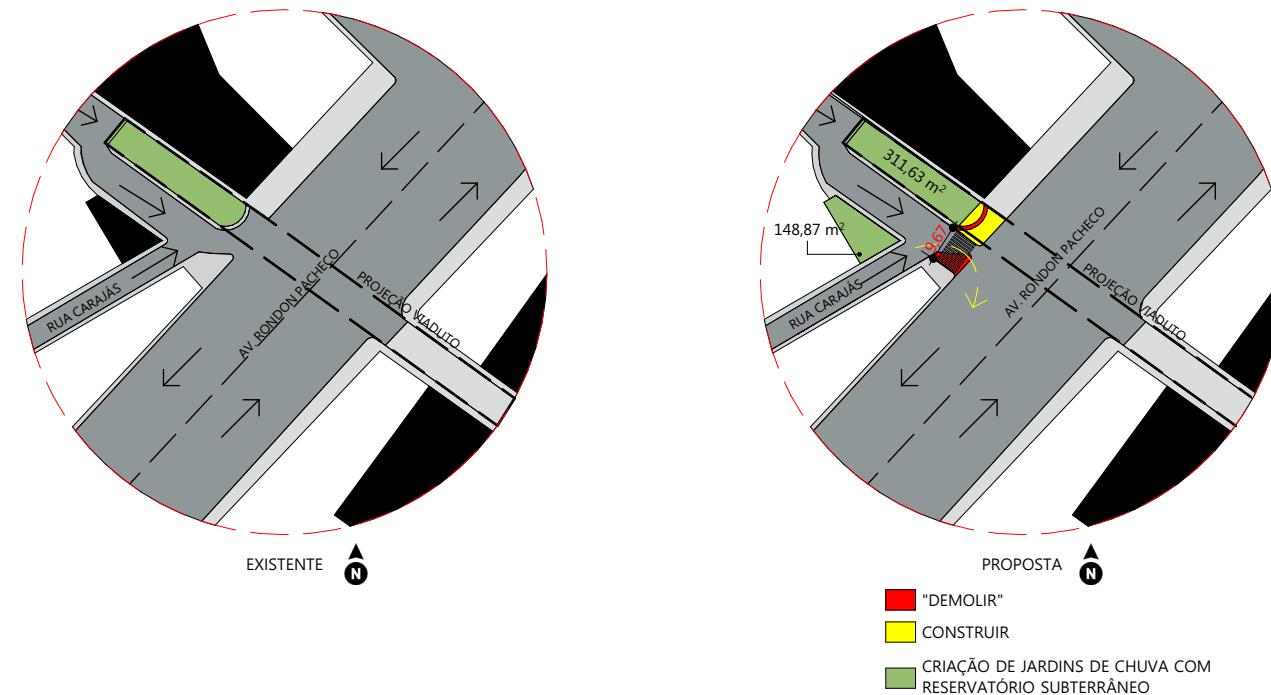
Planta de reconfiguração viária. Escala 1:1.000
